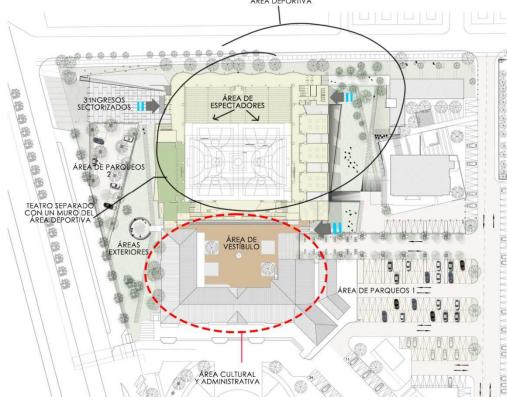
Análisis en planta de Centro de Encuentro Chimkowe (Fuente: Elaboración Propia)
